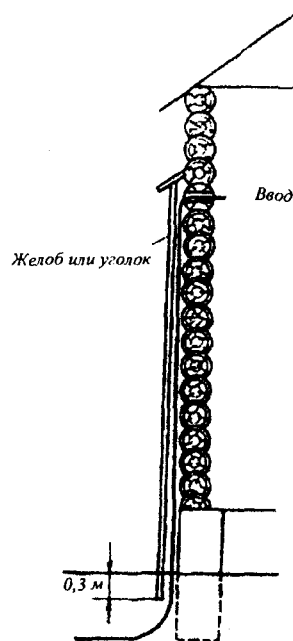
Ввод кабеля в здание по наружной стене.
